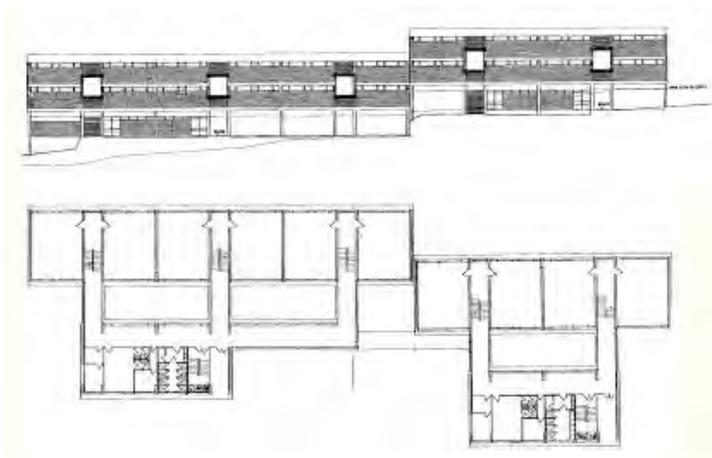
Planta primera y sección longitudinal, colegio de primaria. Proyecto (1963).
